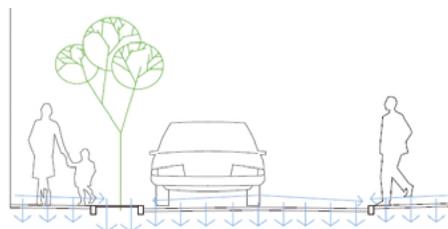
Esquema de pavimento con pendiente orientada hacia los elementos auxiliares.
